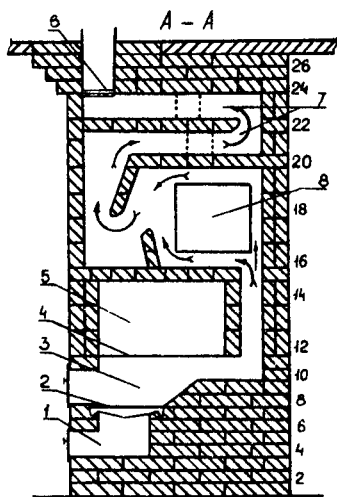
Отопительно-варочная печь № 1, разрез по линии А — А: 1 — зольник; 2 — колосники; 3 — топливник; 4 — плита; 5 — варочная камера; 6 — задвижка; 7 — горизонтальные дымообороты; 8 — духовка
